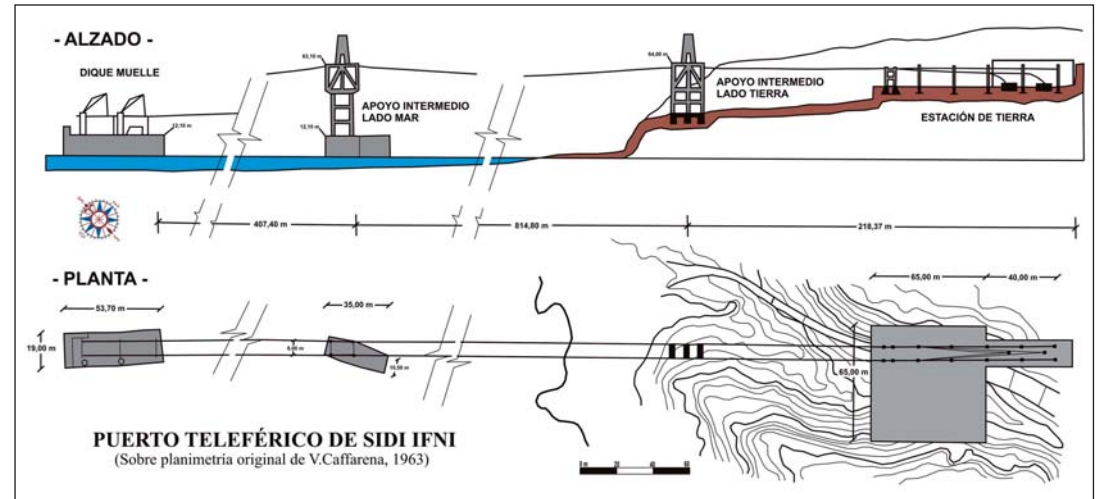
Planta y alzado del puerto teleférico realizado (sobre planimetría original, CAFFARENA 1963a:64).
